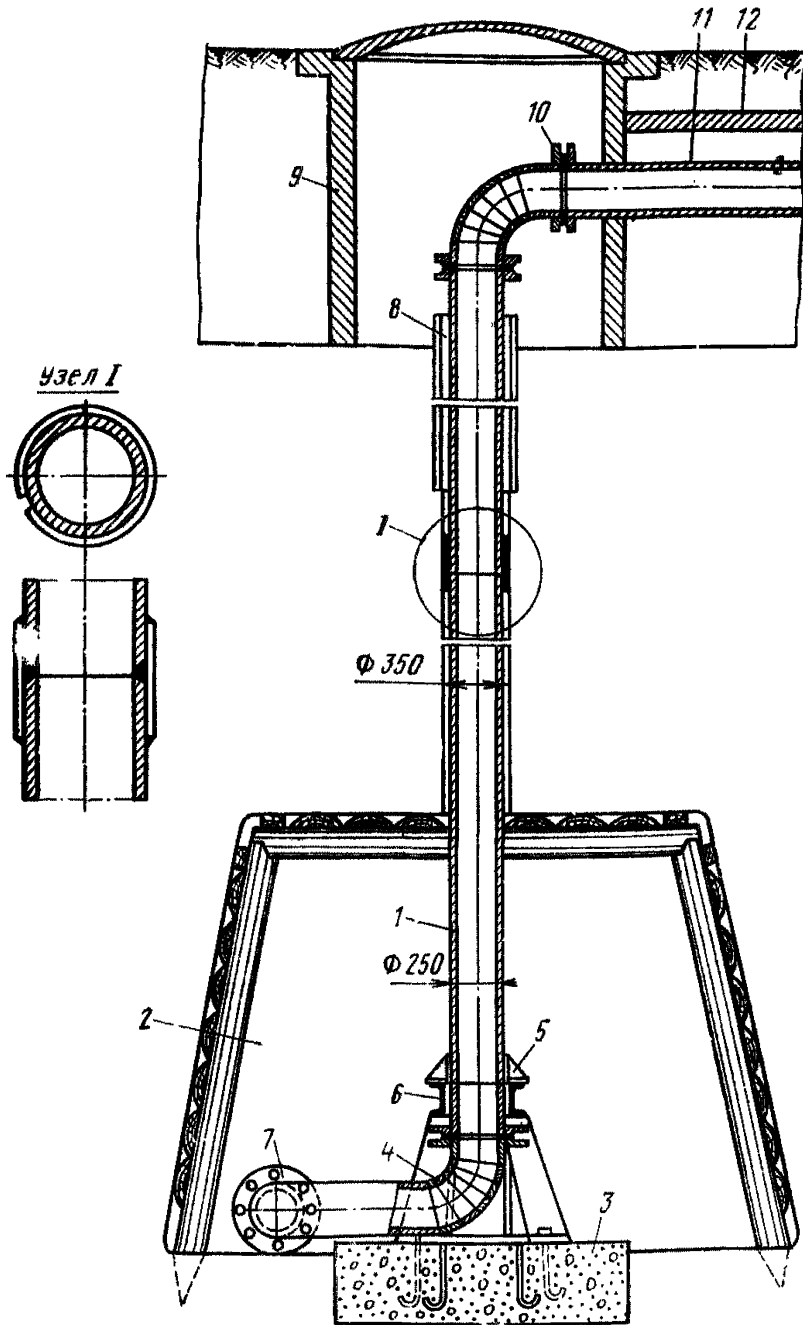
Монтаж и оборудование газопровода в магистральной скважине:
